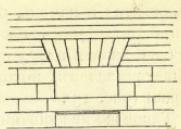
Перекрытие отверстий перемычками изъ плиты.
